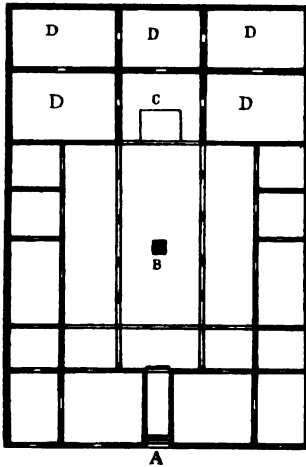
Grundriss eines griechischen Hauses.
